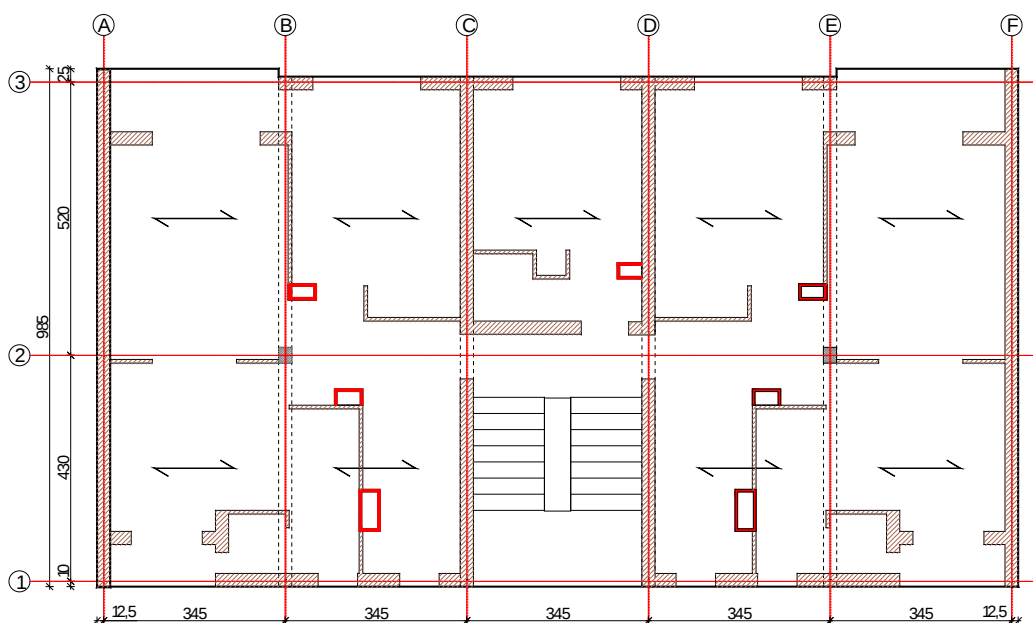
Planimetria e katit karakteristik të ndërtesës A1, M34H – Murature pa përforcime
